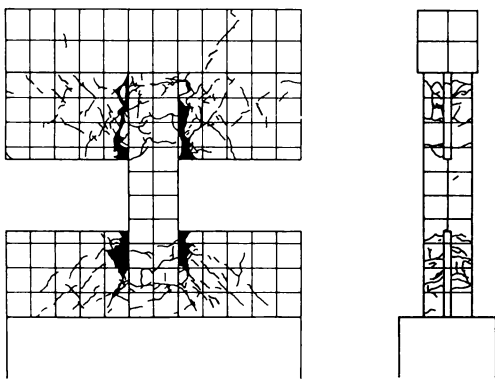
(b) 試験体 CSS02 の実験終了時のひび割れ図
